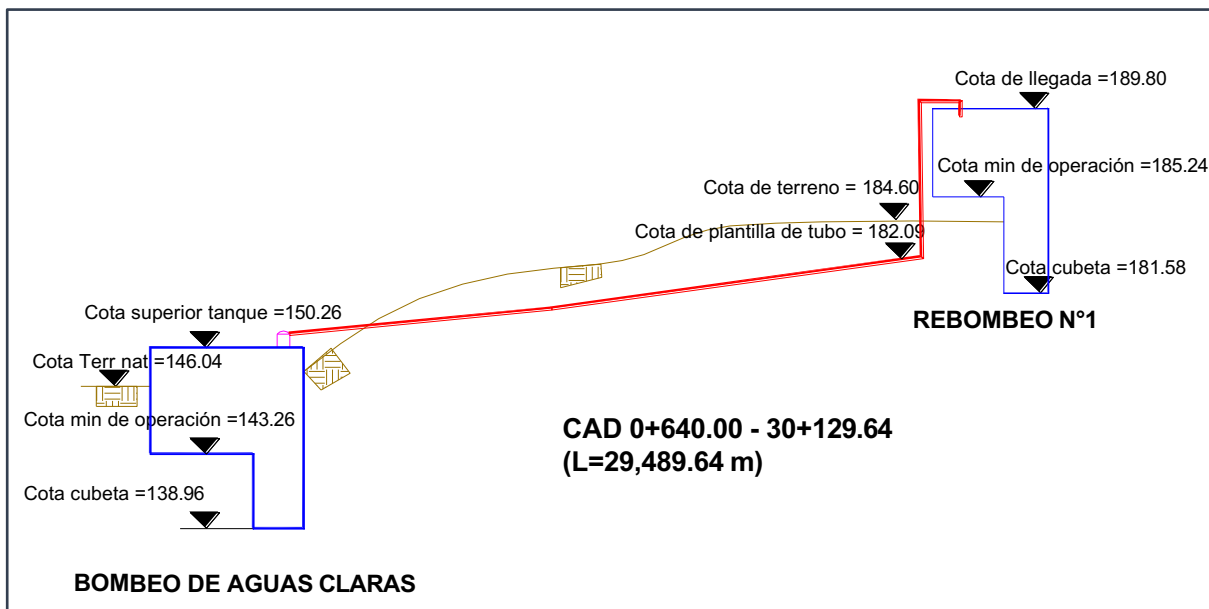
Tramo de planta potabilizadora (tanque de aguas claras) a rebombee No. 1
